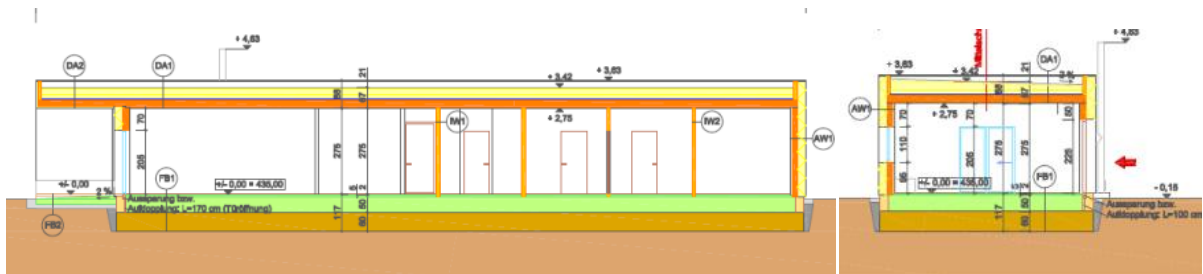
Schnitte Modellgebäude in massiver Bauform jedoch mit minimalen Fensterflächen lt. Bauordnung
